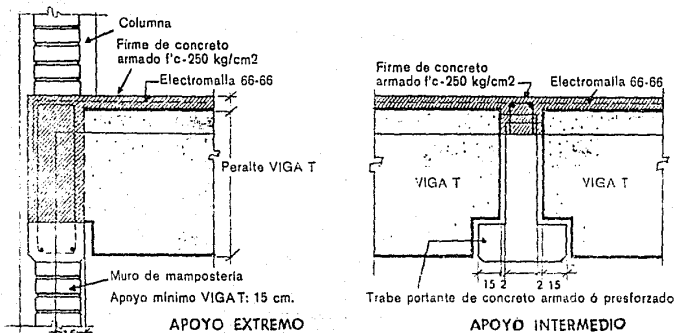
CONEXION DE VIGA "T" A TRABES PORTANTES EXTREMAS E INTERMEDIAS
